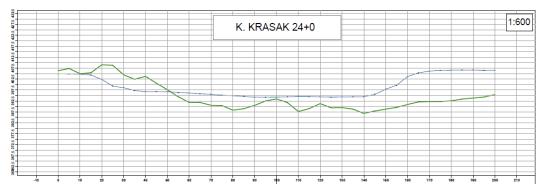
Tampilan Cross section 3 Sungai Krasak bagian hilir
